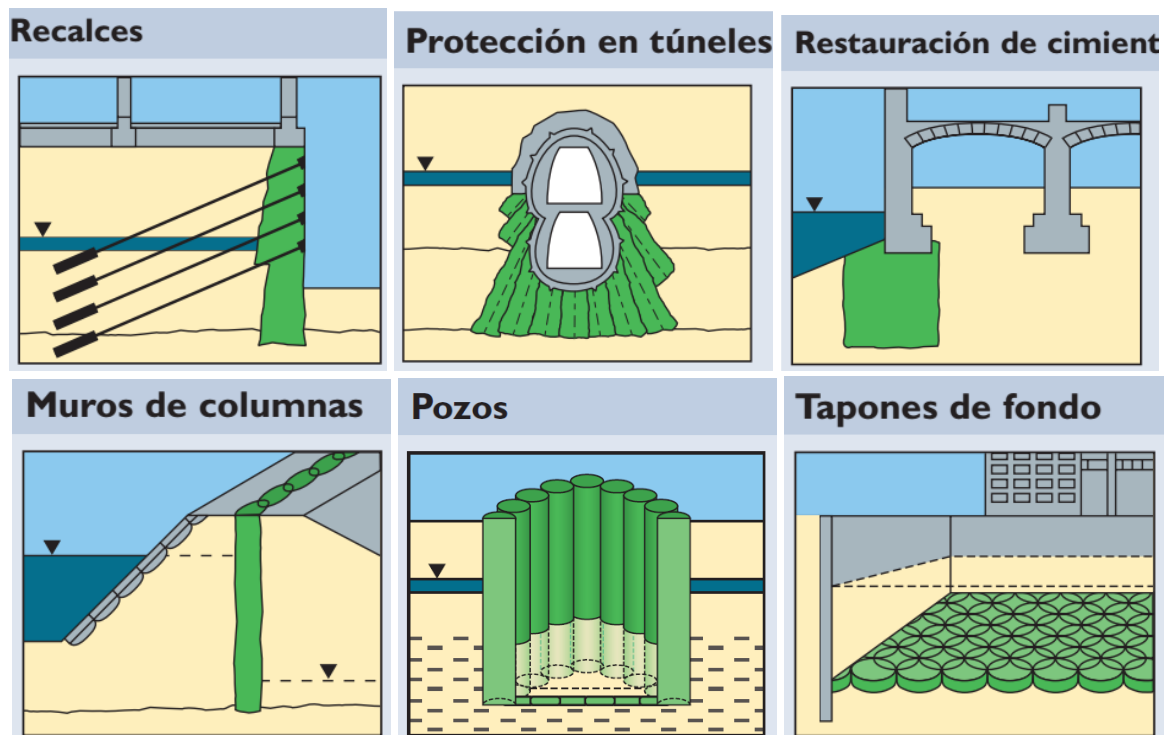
Ejemplos de aplicación del Jet Grouting – Soilcrete® de Keller.
